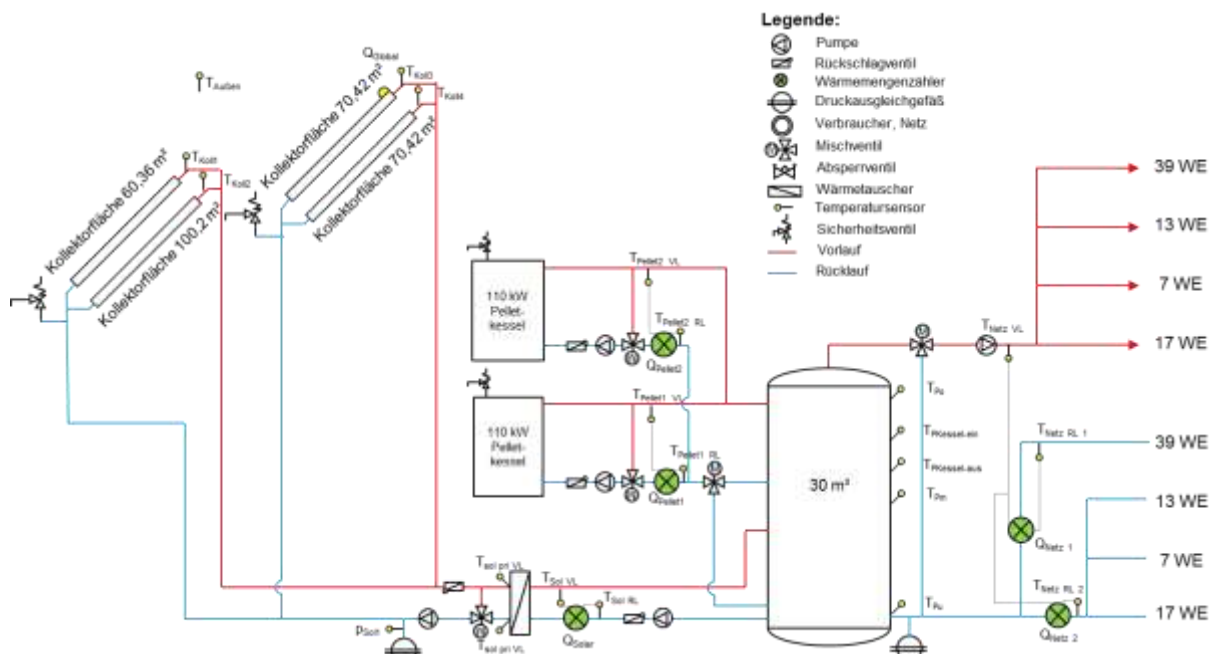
Hydraulik- und Messkonzept zum Bauvorhaben Nahwärme St. Johann/Pongau
